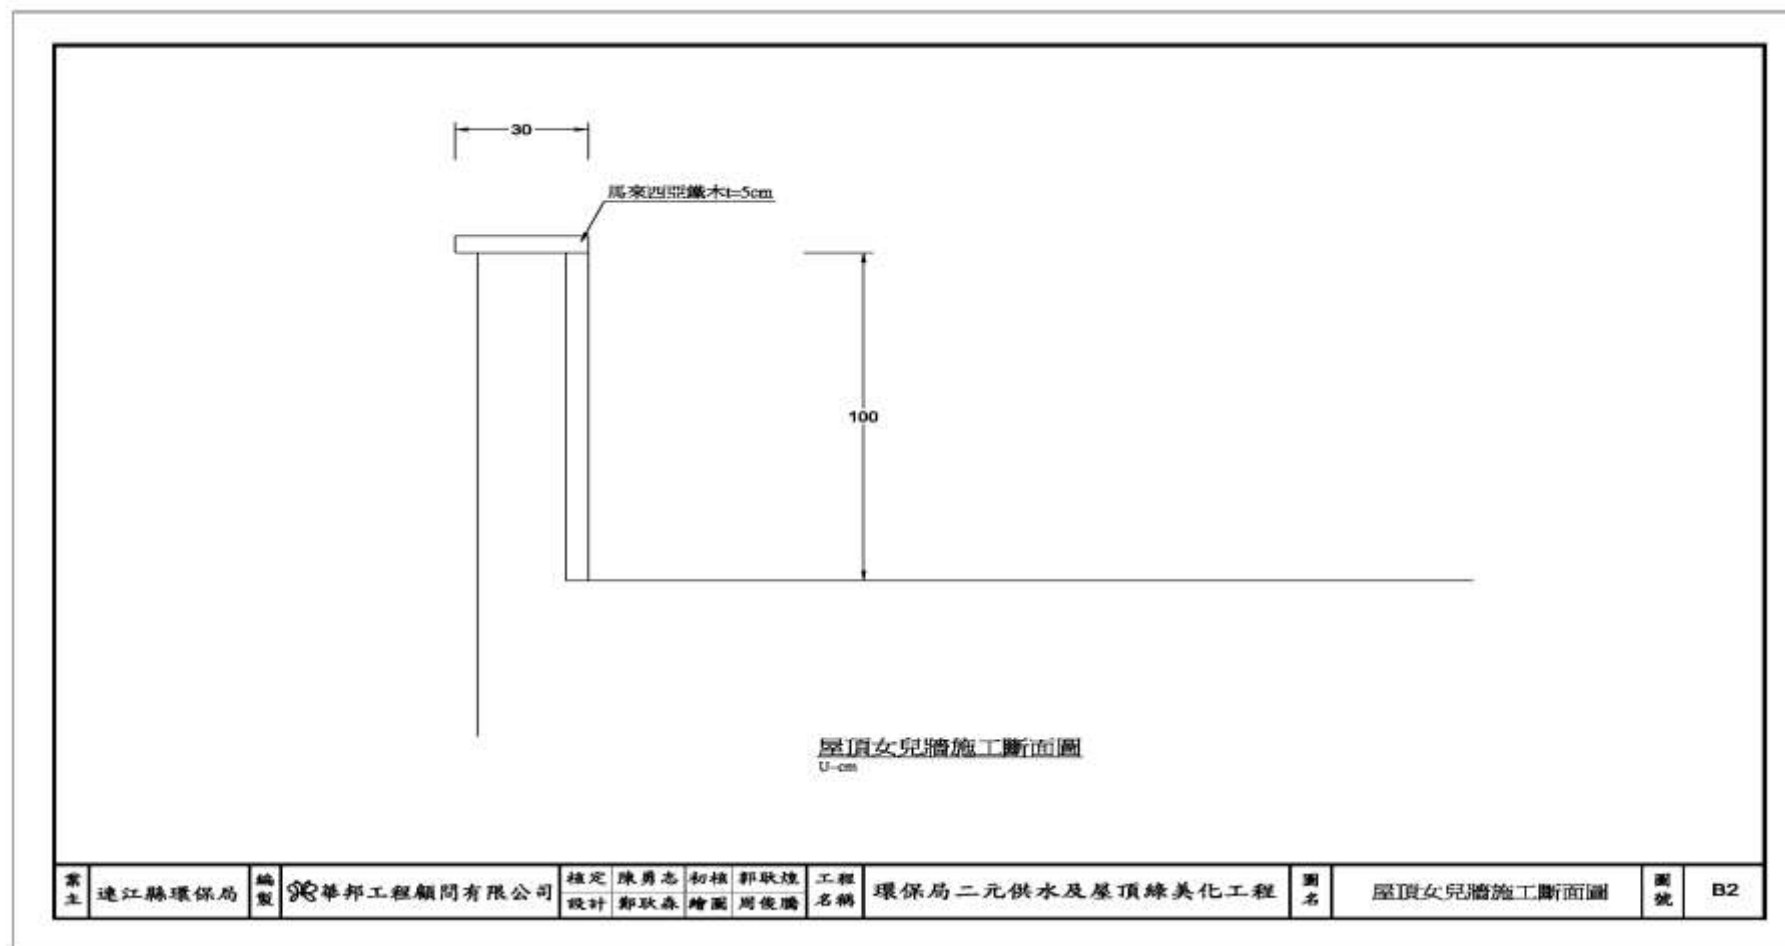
低碳環保觀光教育園區屋頂綠化改造示意圖-屋頂施工斷面圖
